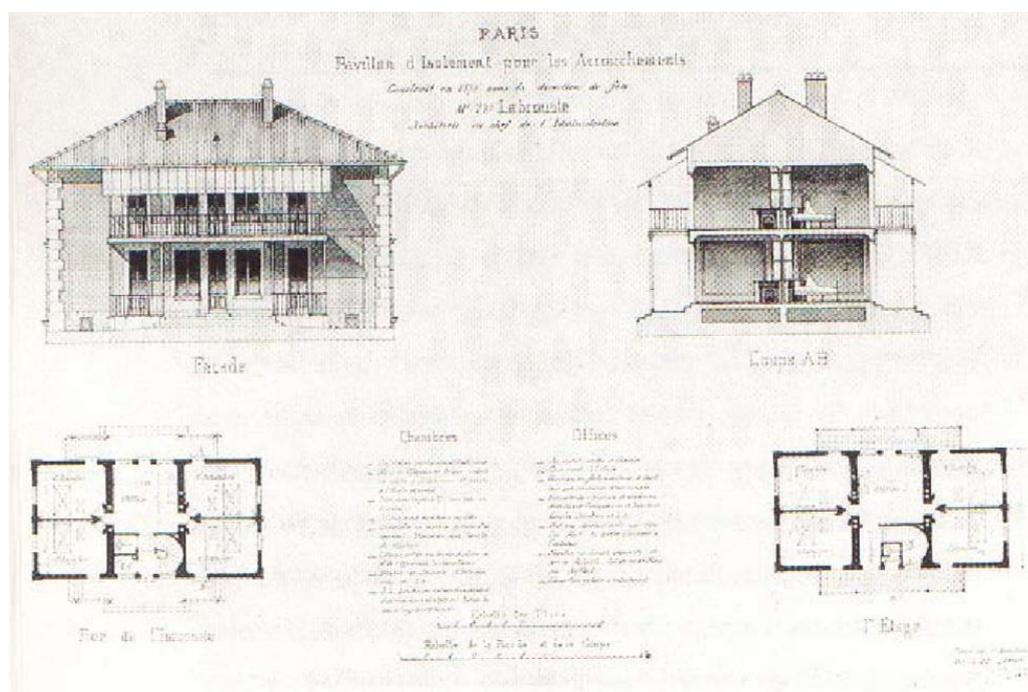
Fachada, corte e plantas baixas do Pavilhão de Isolamento da Maternidade de Paris.
